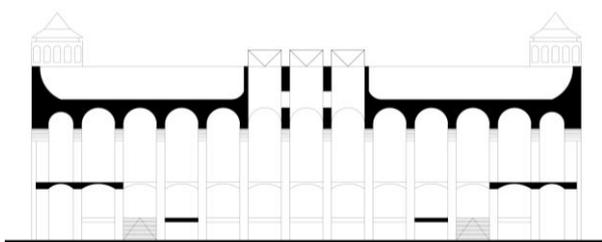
CLOTET-PARICIO, Sección transversal proyecto
